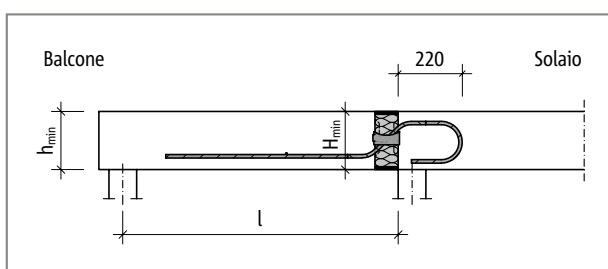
Schöck Isokorb® T tipo QL-V4 - QL-V6: sistema statico
